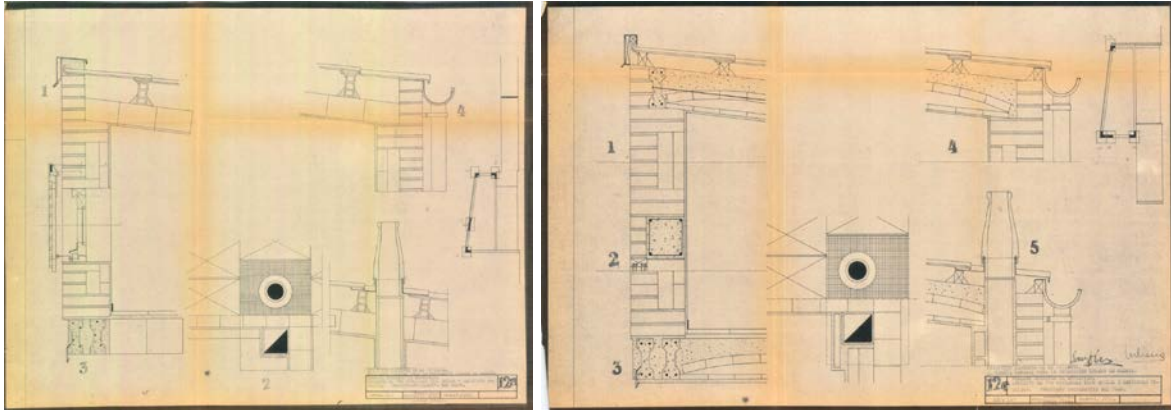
(izda.). Entrevías, Primera Fase, Planos 12a, Vivienda de tipo A, Detalles Constructivos
